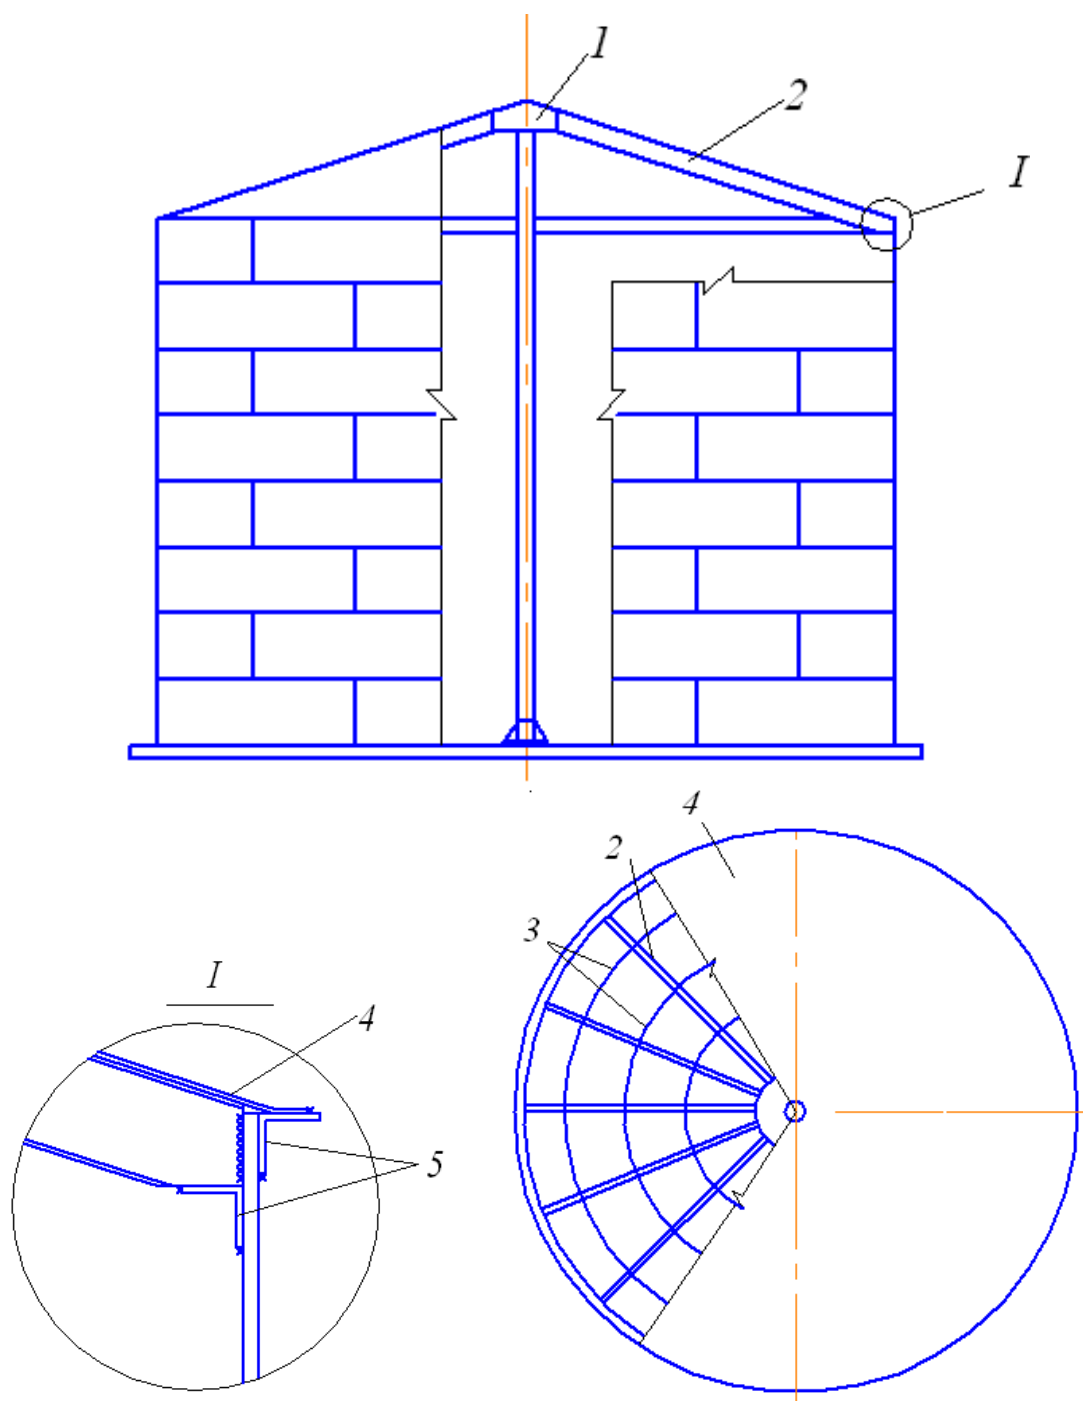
Конструкция вертикального резервуара с конической крышей:
